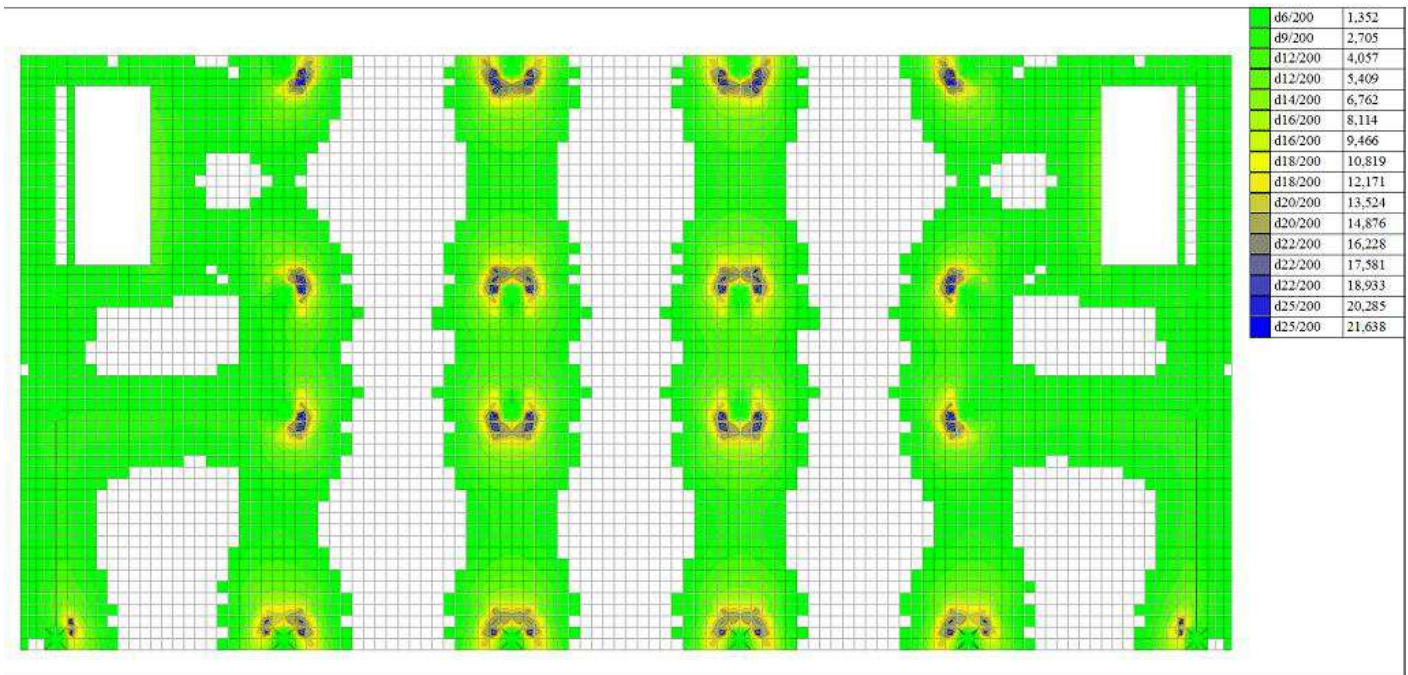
Схема верхнего армирования плиты по оси x
